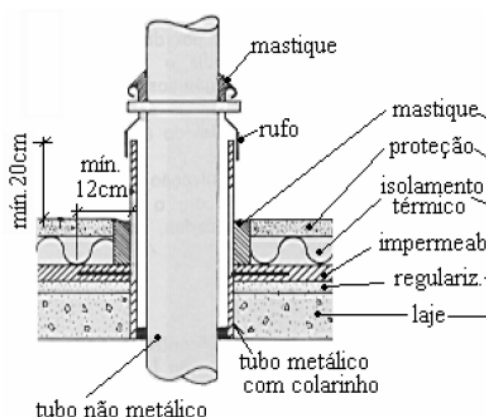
Utilização de mastique para preenchimento de junta. Disponível em [http://www.npc.ufsc.br/gda/humberto/Aula\\_impermeabilizacao.pdf](http://www.npc.ufsc.br/gda/humberto/Aula_impermeabilizacao.pdf)
